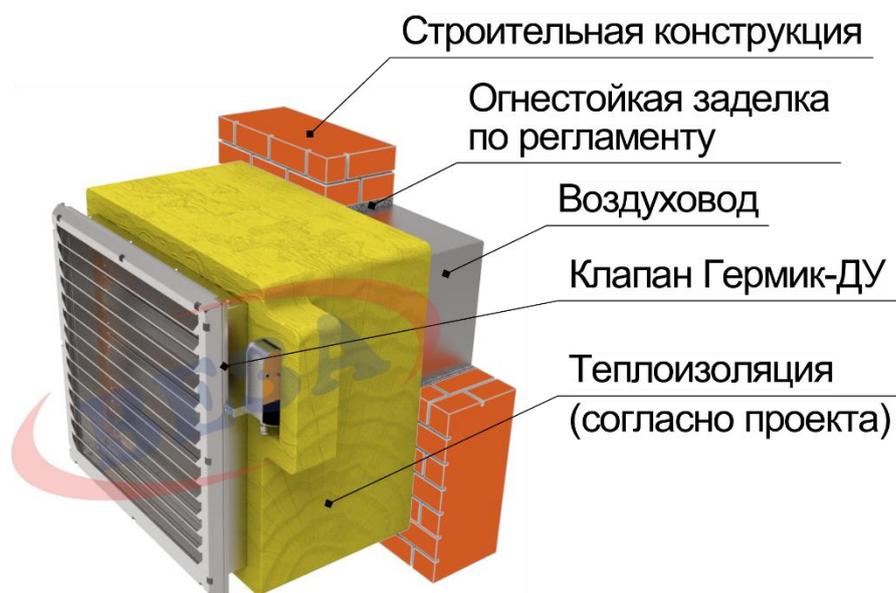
Монтаж клапана канального типа вне проема строительной конструкции
